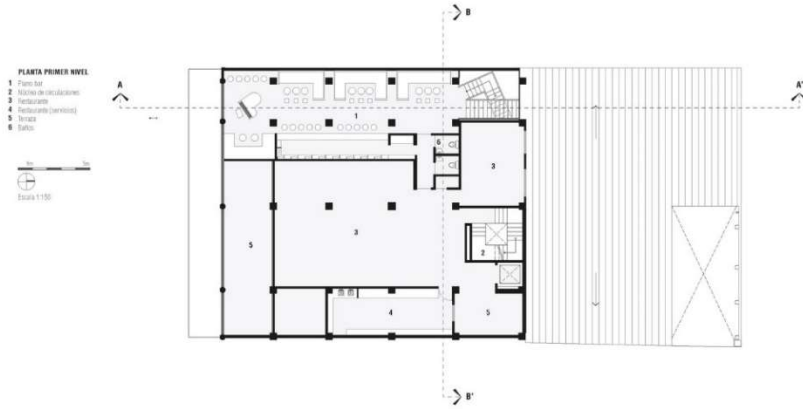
Planta Baixa Mezanino - Mercado Roma
